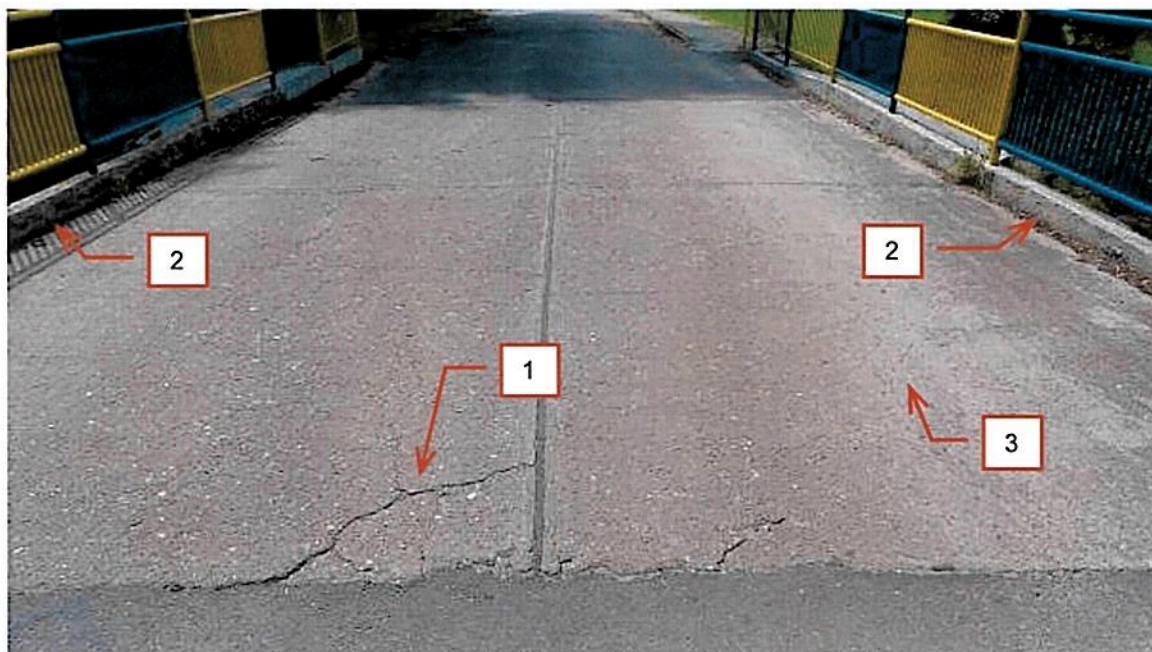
Dojazd od strony południowej. Zanieczyszczenie gruntem w strefach ścieków przykrawężnikowych (1).
